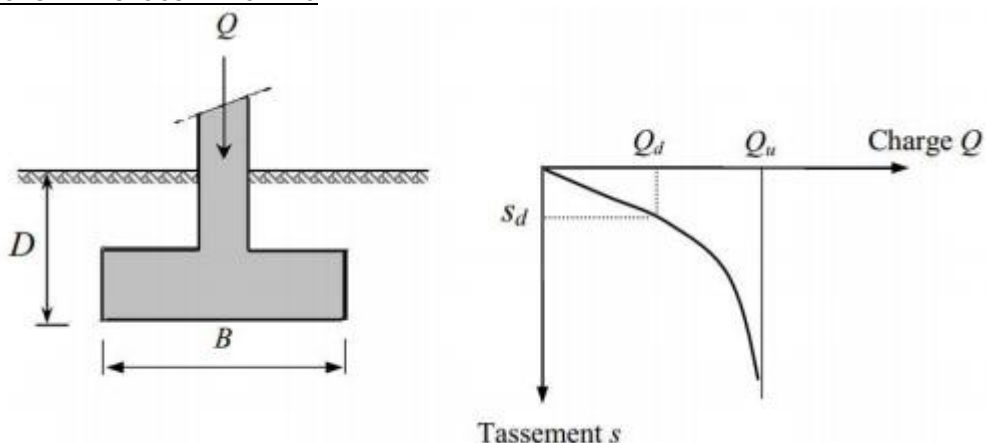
Chargement d'une fondation superficielle (Terzegli, 1943)
